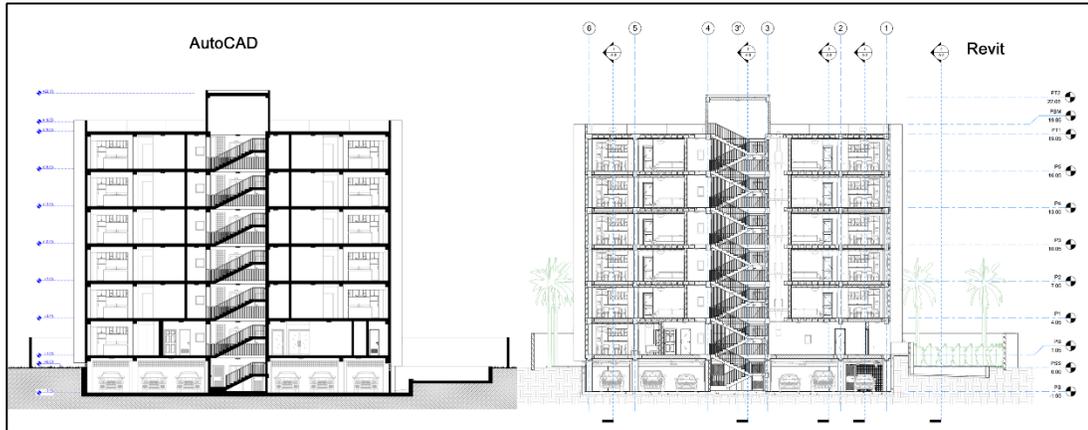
Comparación de vistas longitudinales con AutoCAD y aquellas con Revit.
